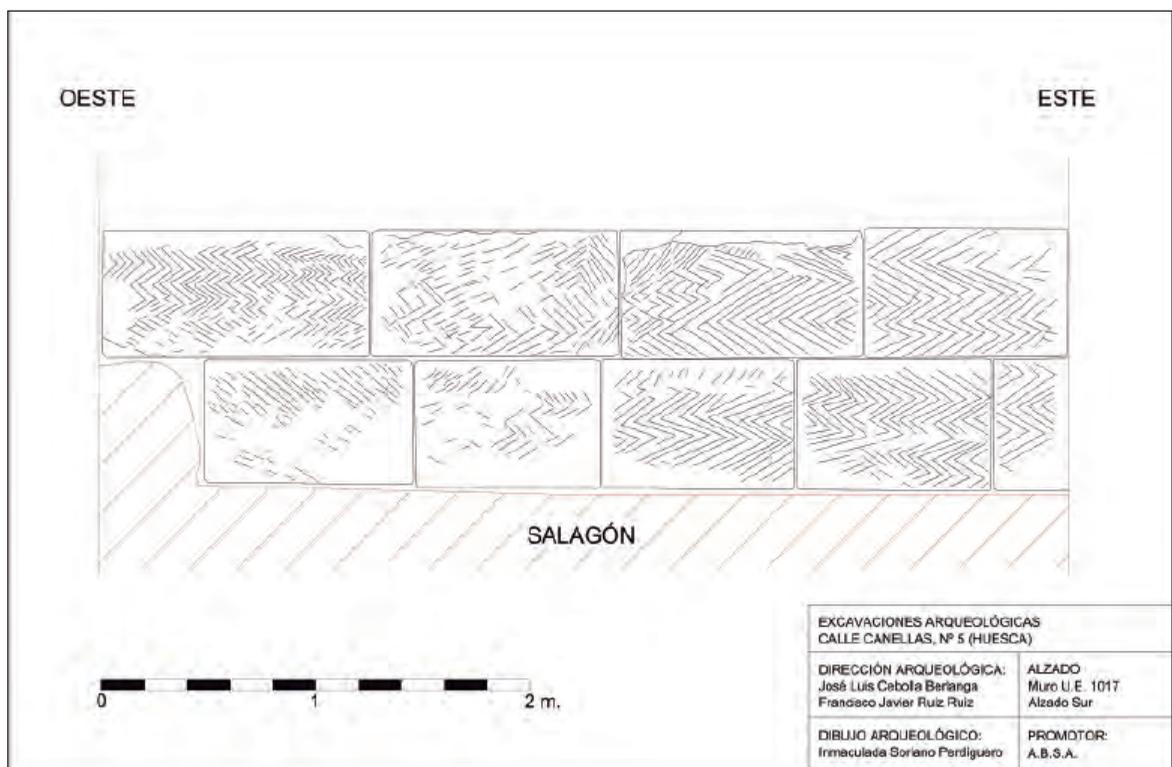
Área 2. Alzado sur del muro UE 1017.
